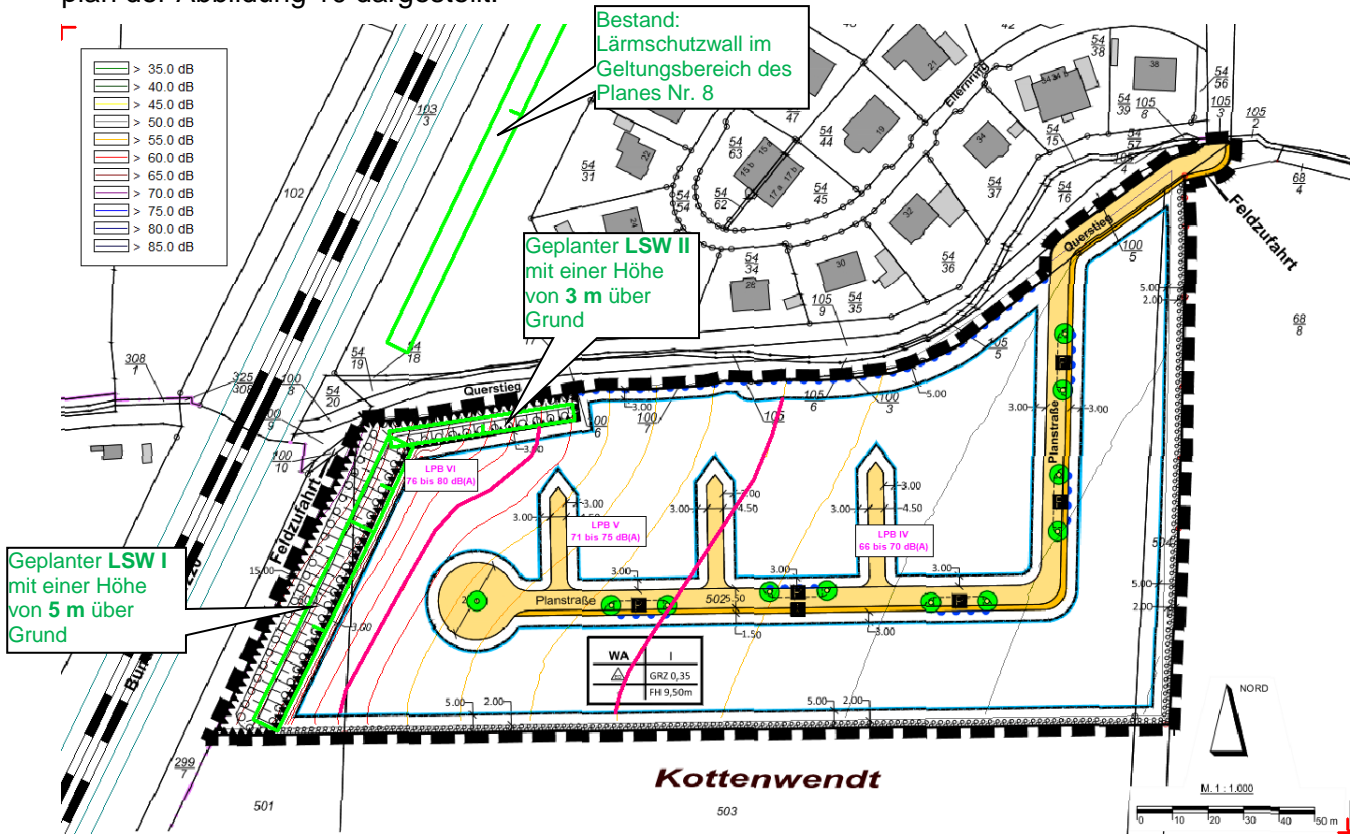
Bebauungsplan Nr. 11 mit Darstellung der Lärmpegelbereiche 5,3 m über Grund
